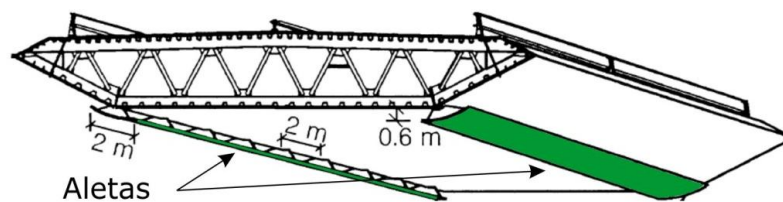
As aletas instaladas na ponte pênsil Storebælt (Larsen, 2000a)
